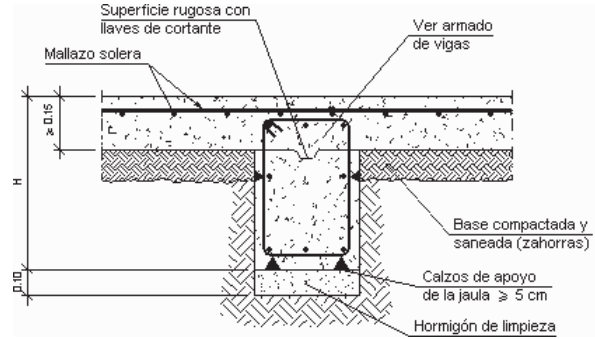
Detalle de la dala de desplante con el firme de concreto armado (maya electro-soldada y concreto simple) ⁴⁰ imagen 2B
